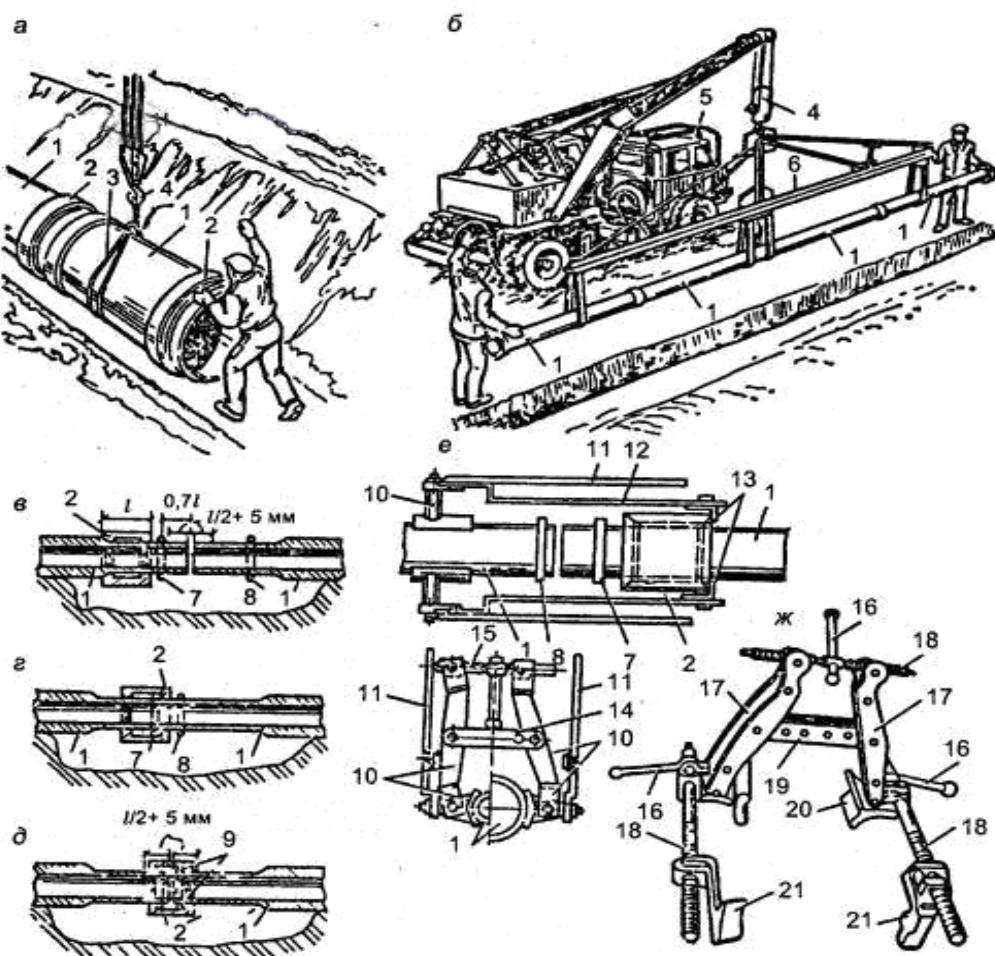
Способы монтажа трубопроводов из асбестоцементных труб:
